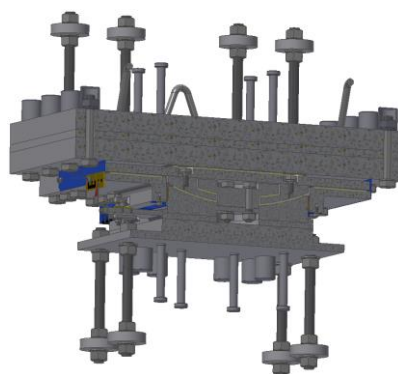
Lagertyp KGZe,L, mit Abhebesicherung und mit Zugankern gegen auftretende abhebende Vertikallasten und klaffende Fugen, beidseitig Betonanschluss.
